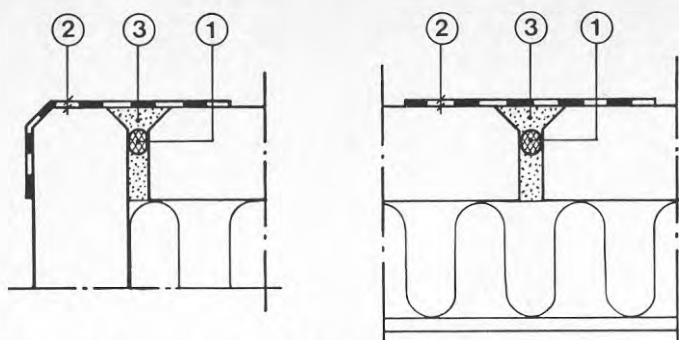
Källaryttervägg av prefabricerade betongelement.
